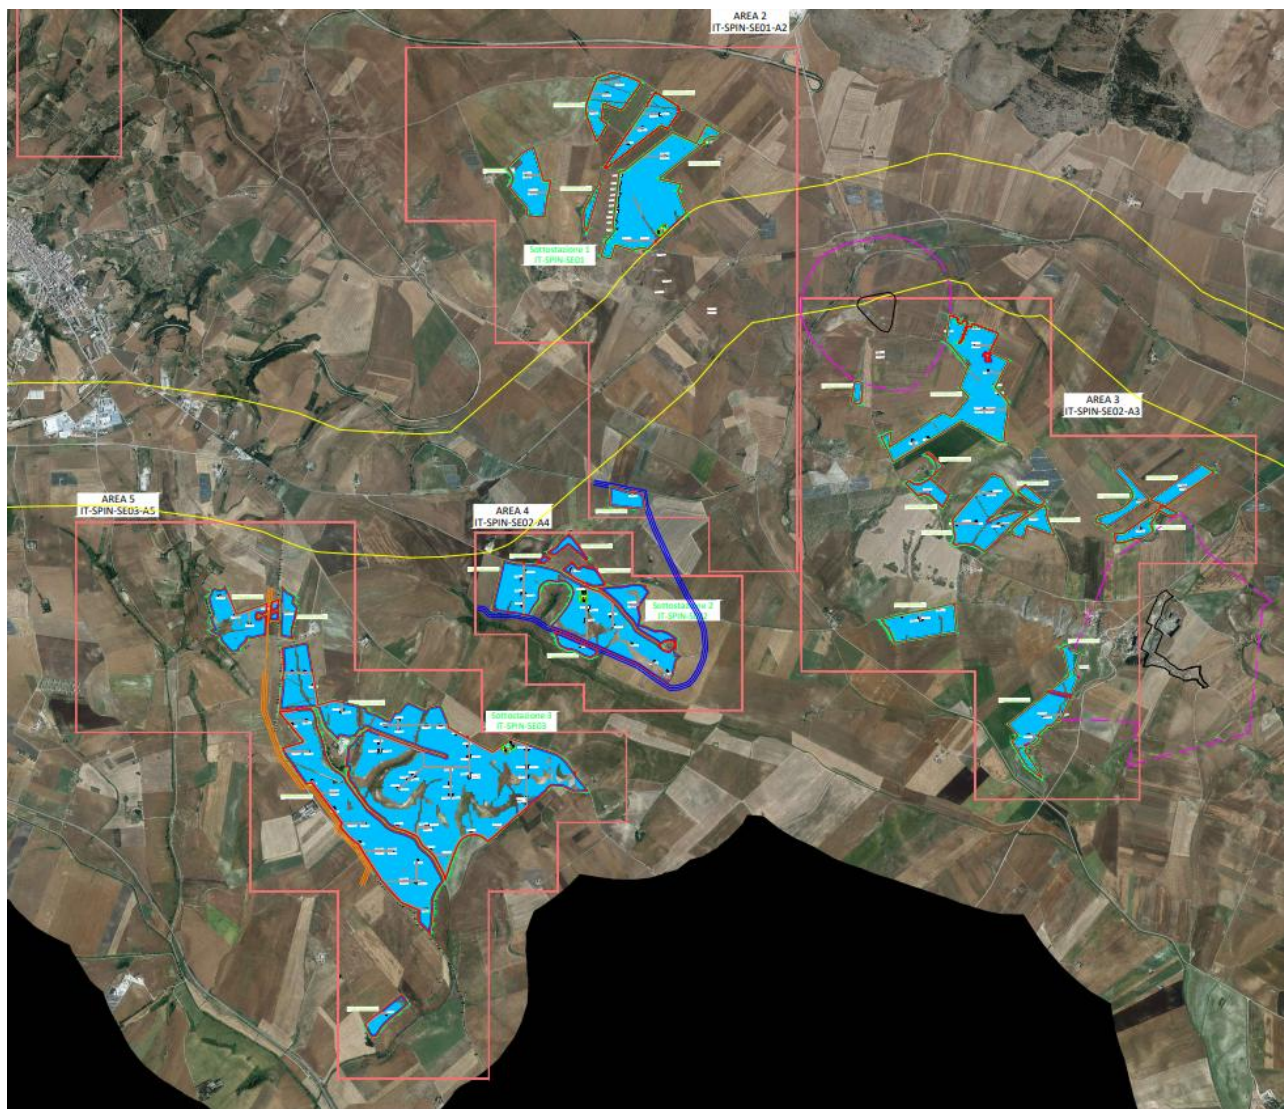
2 - Particolare del layout di impianto su ortofoto – aree A2, A3, A4, A5
